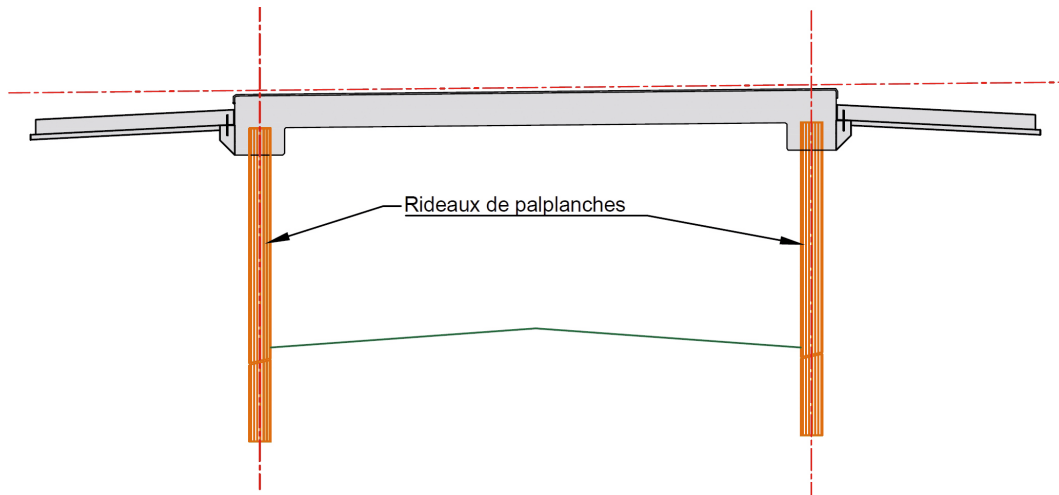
Ouvrage de franchissement de la Vaire à Fère-Champenoise (51) avec palplanches encastrées dans le tablier (crédit : DIR Est)
